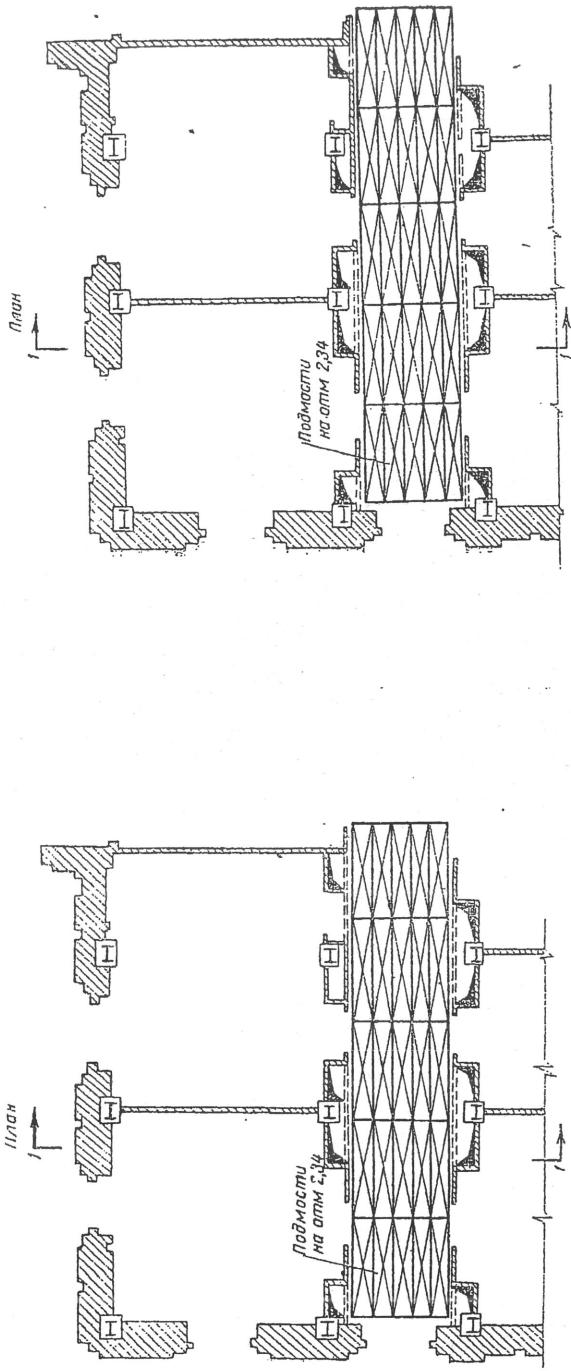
Продолжение третьего этапа — кладка коридорных стен, обращенных в комнаты, до балки перекрытия
